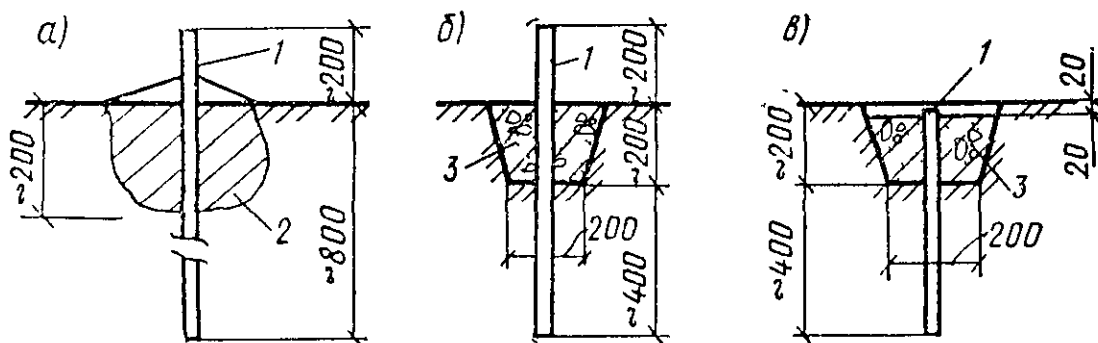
Конструкции деформационной (грунтовой) марки, где а - простейшего типа; б - с бетонной опорой; в - с бетонной опорой в зимнее время; 1 - арматурный стержень  $d=16-24$  мм; 2 - уплотненный грунт, 3 - бетонная опора
